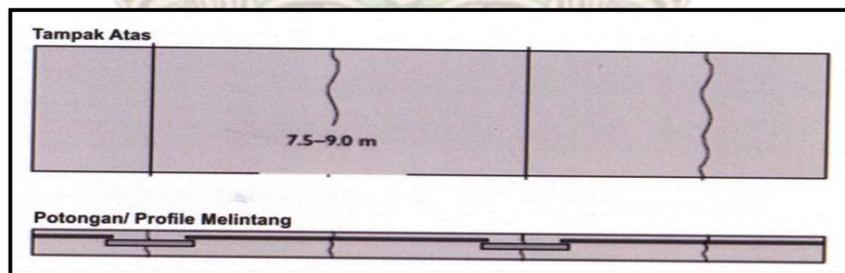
Perkerasan Beton Tanpa Tulangan
